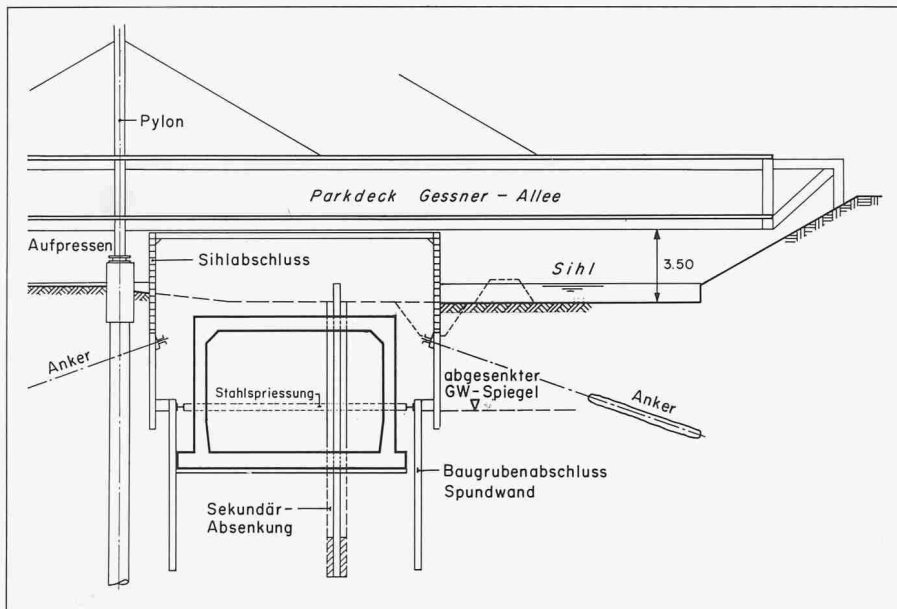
Baugrube unter dem Parkdeck, Querschnitt
